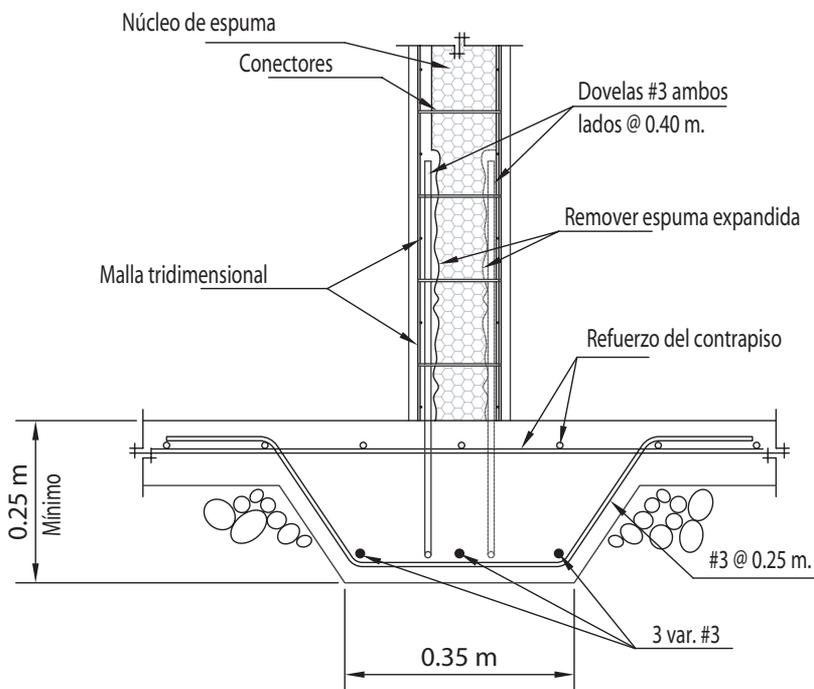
Fundación para paredes tipo emparedado con malla tridimensional y relleno de espuma expandida.
